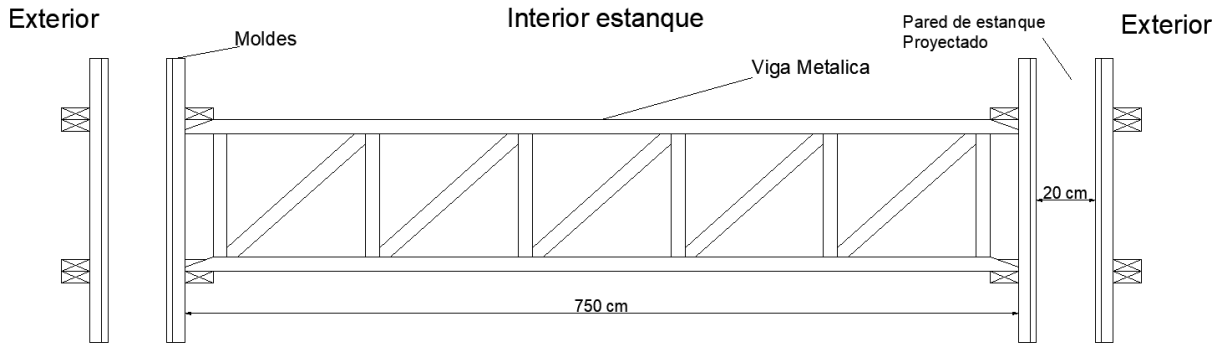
Detalle de Viga Metálica. Vista lateral
